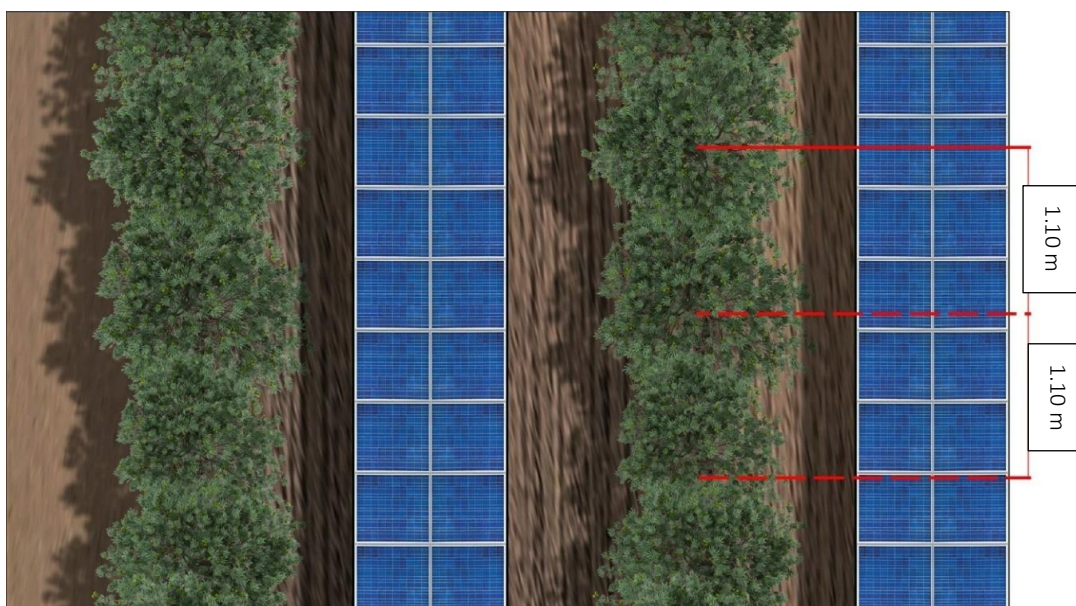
Tipologico – Vista Planimetrica dell'impianto Olivicolo.
